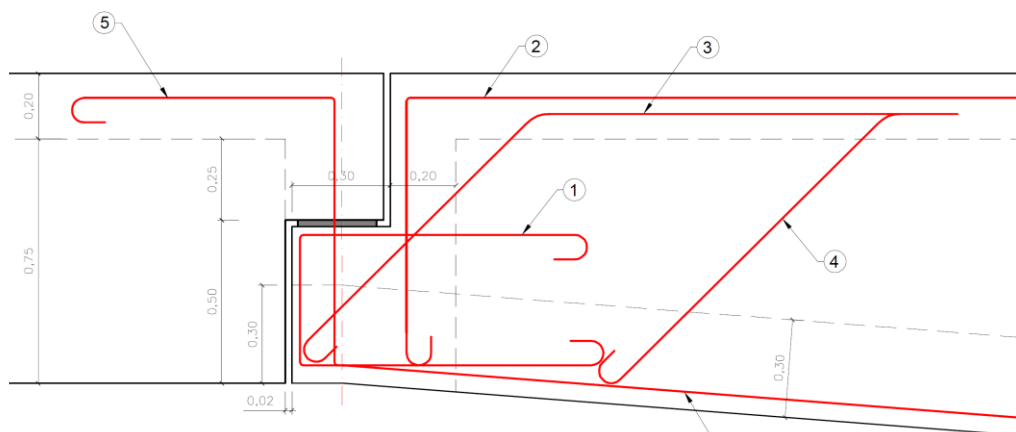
Croquis de armadura existente definida en el proyecto de la estructura.
